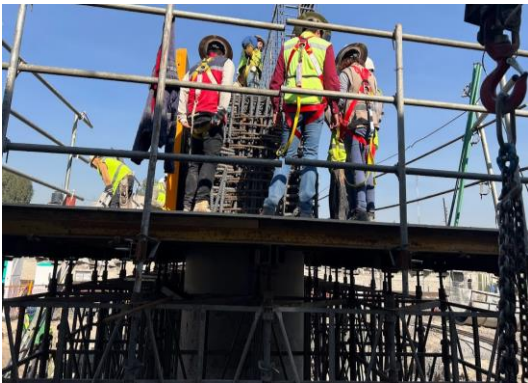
y 195 Autoría Propia (2023) "Revisión y vista armado superior en columnas de caballetes (estribos)"
